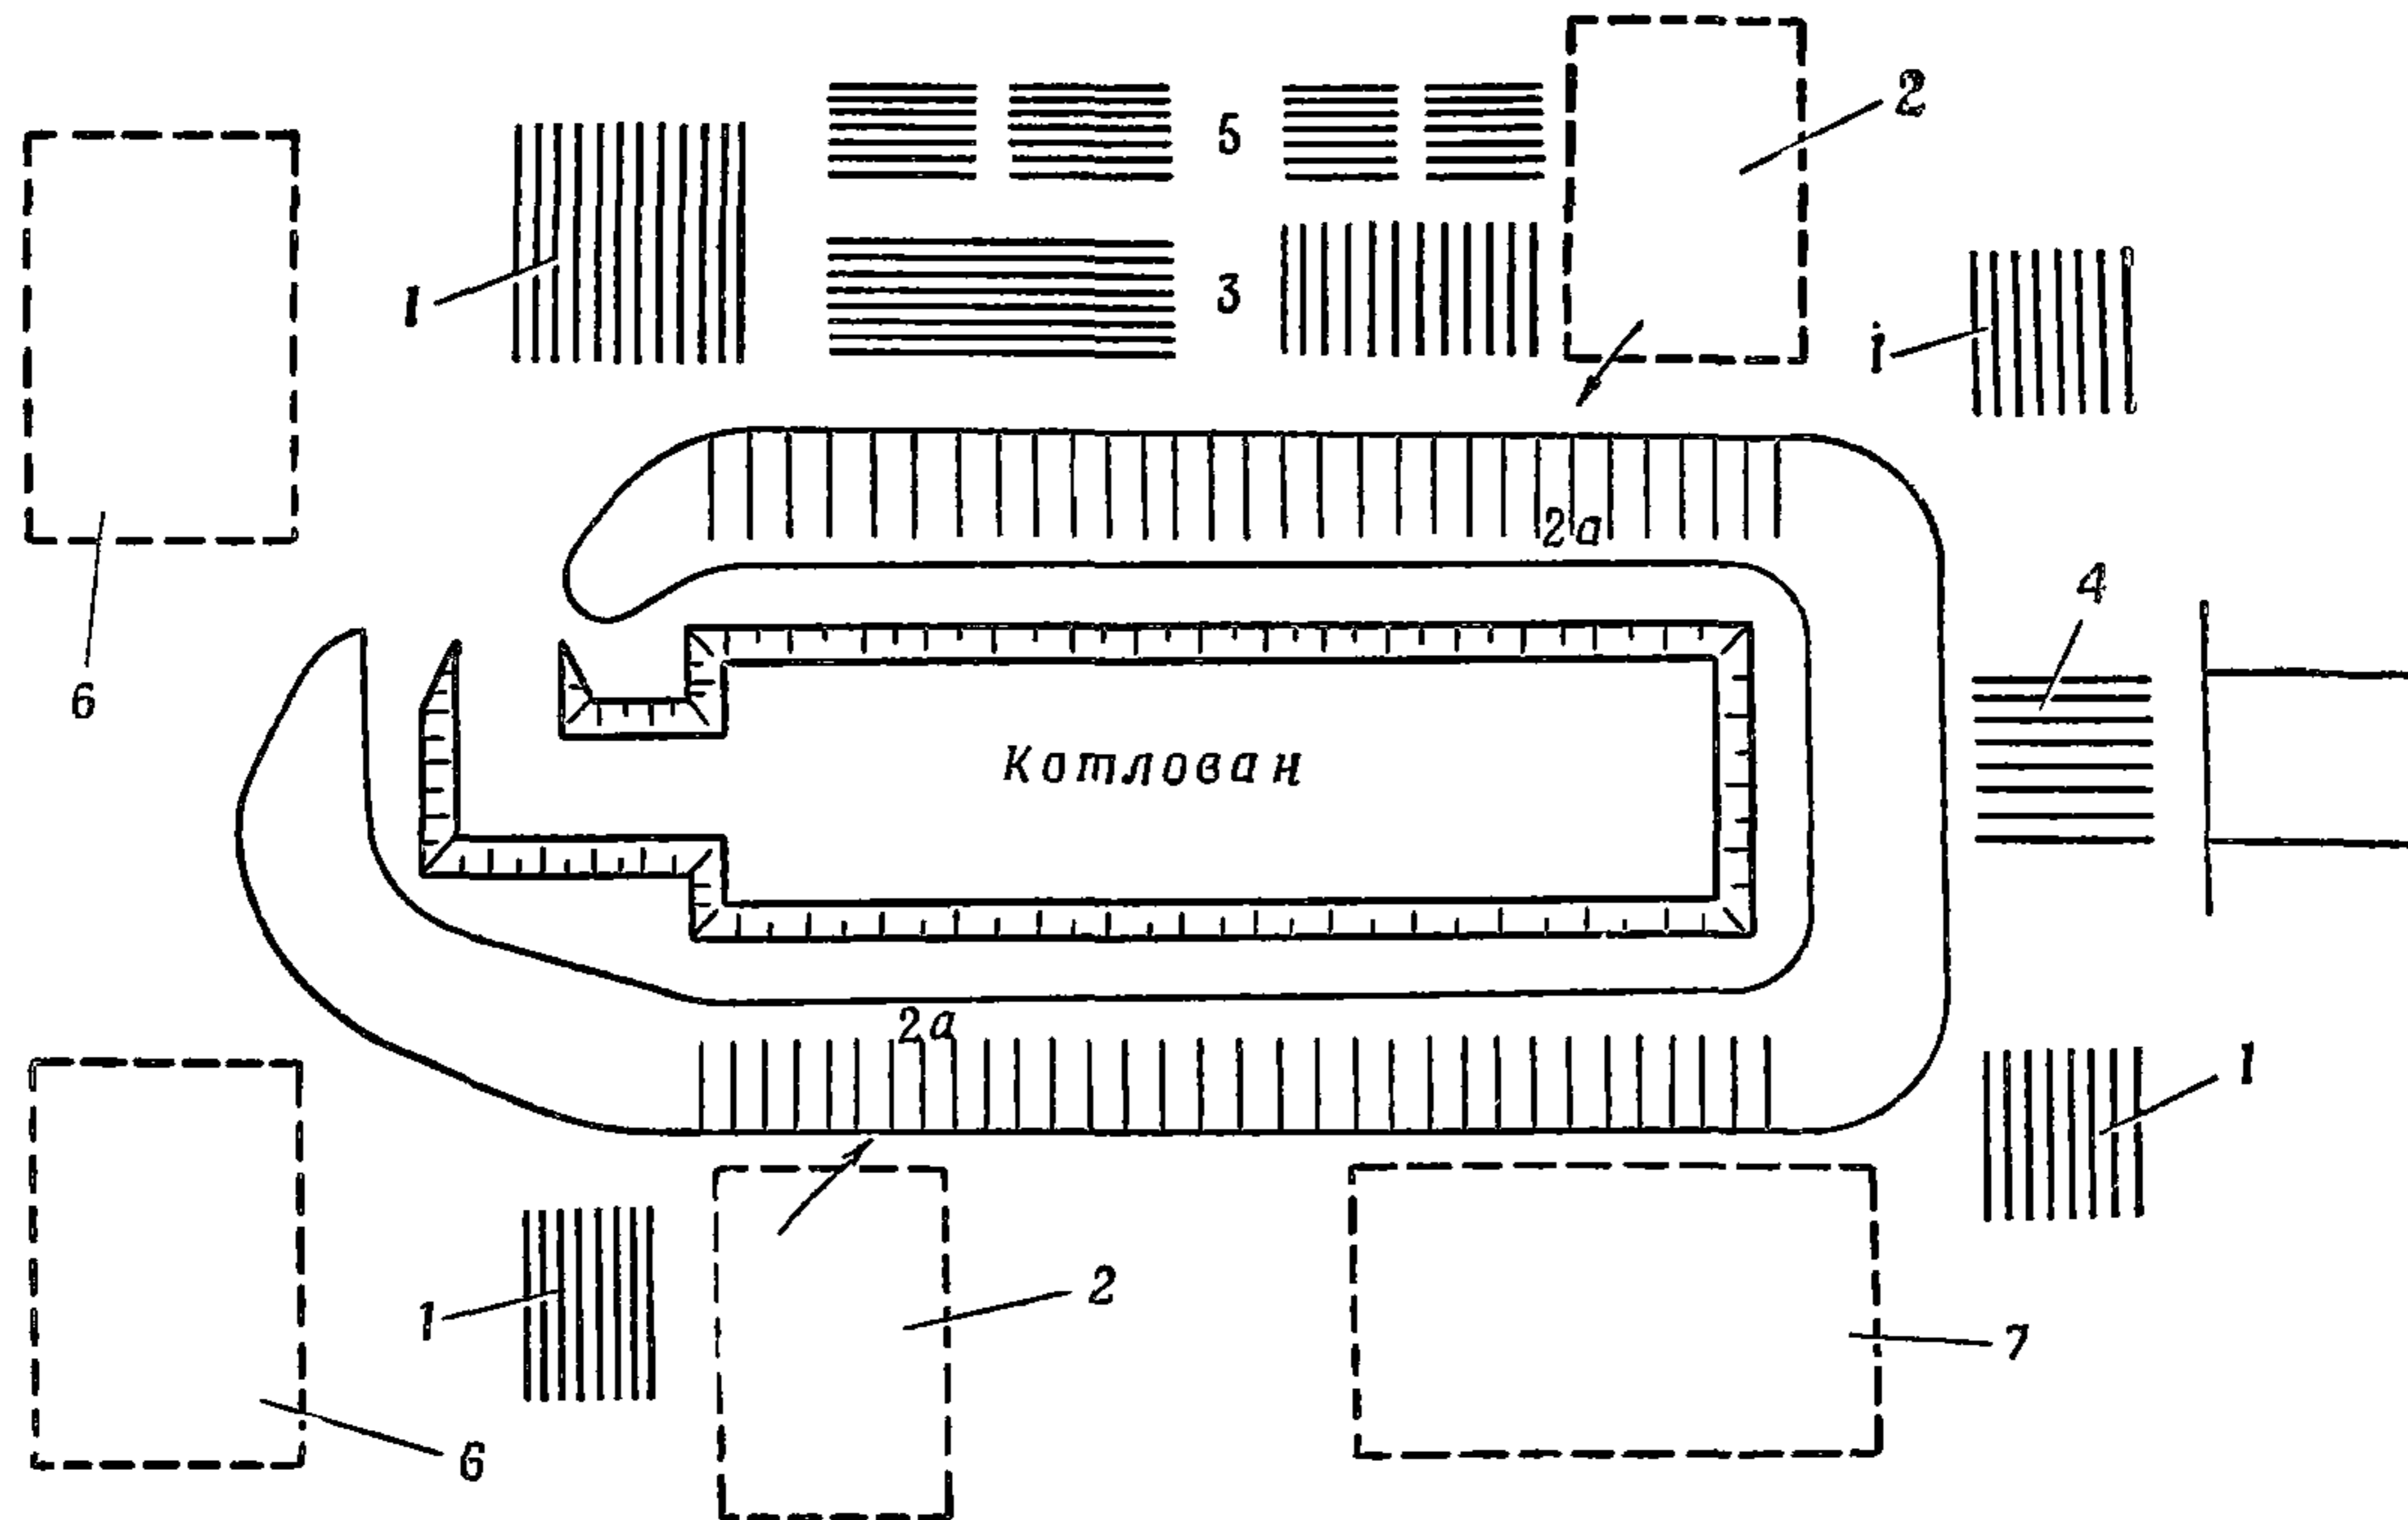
Схема раскладки элементов сооружения из круглого леса перед сборкой:
